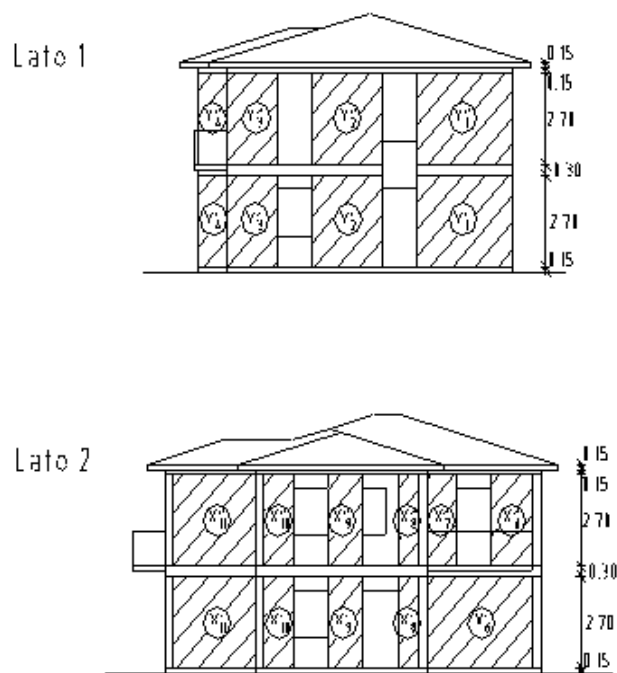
Prospetti con indicazione degli elementi resistenti
